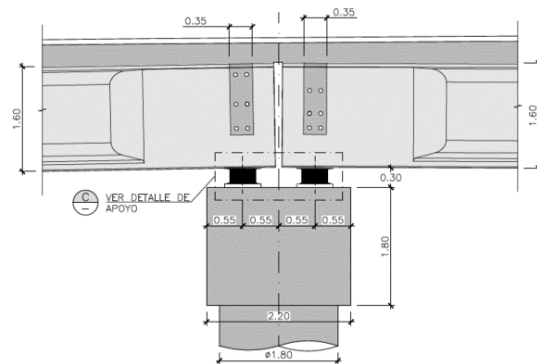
Detalle apoyo pila E-11 con aislamiento sísmico.
